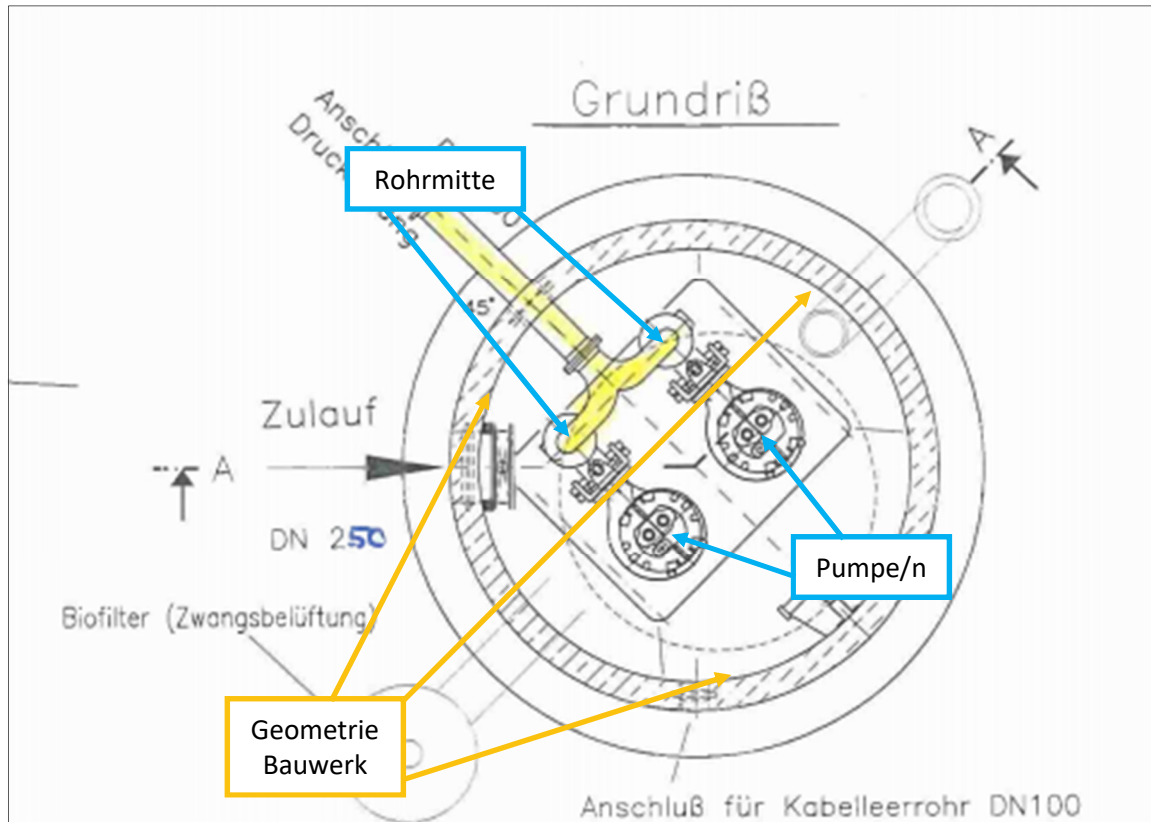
Abwasserpumpanlage (APA) Grundriss
